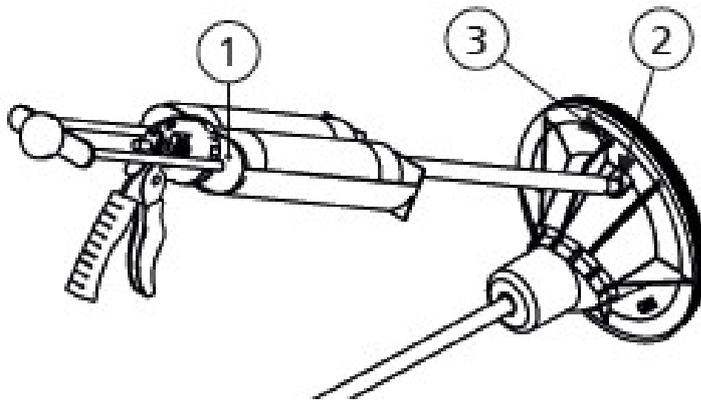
Glasfaser-Hauseinführung Hauff GFH 20 - Herstellerzeichnung.
